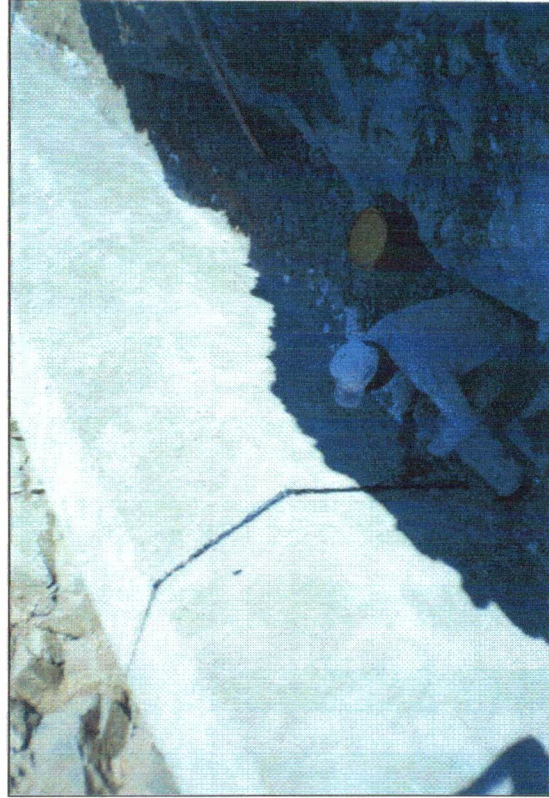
Rejuntamento com mastique elástico da junta de dilatação.
